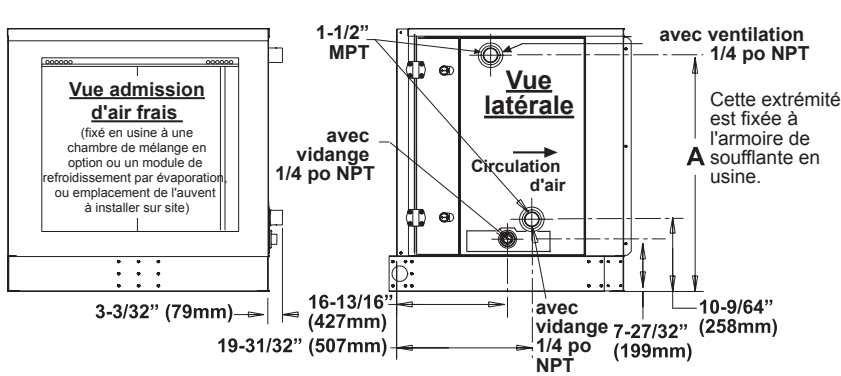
Dimensions du module serpentín de refroidissement à eau glacée
